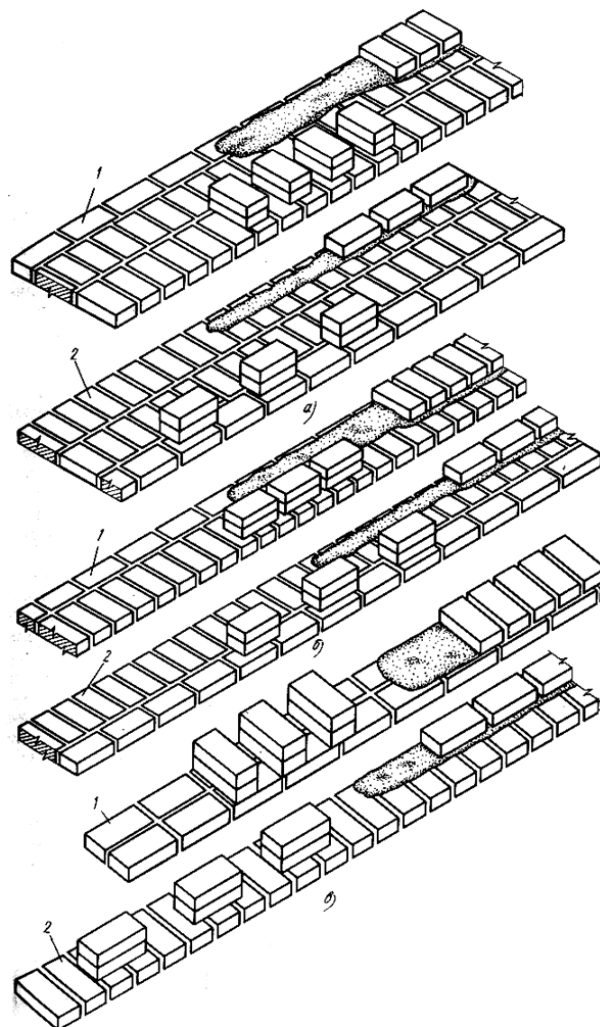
Раскладка кирпича при кладке стен толщиной:
